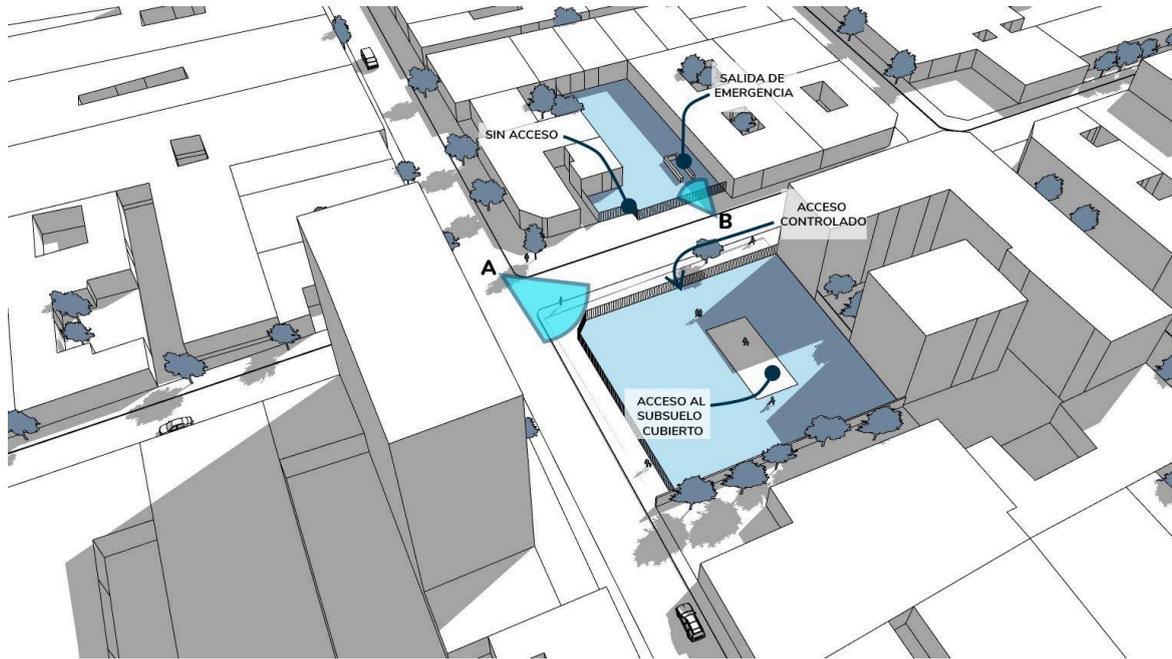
Vista 3d del terreno.. Fuente: Elaboración propia.
